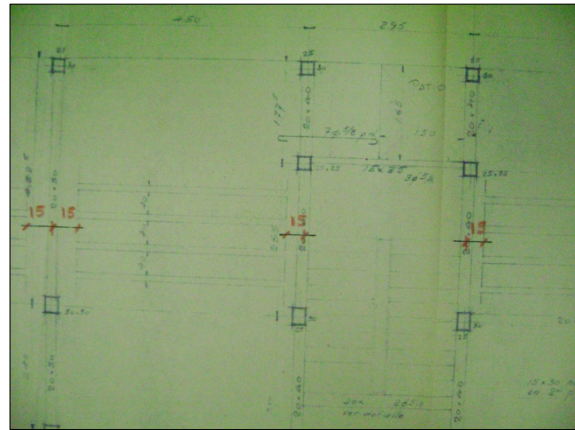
Fotografía de Plano de Estructura de Armado de Losas y Vigas
